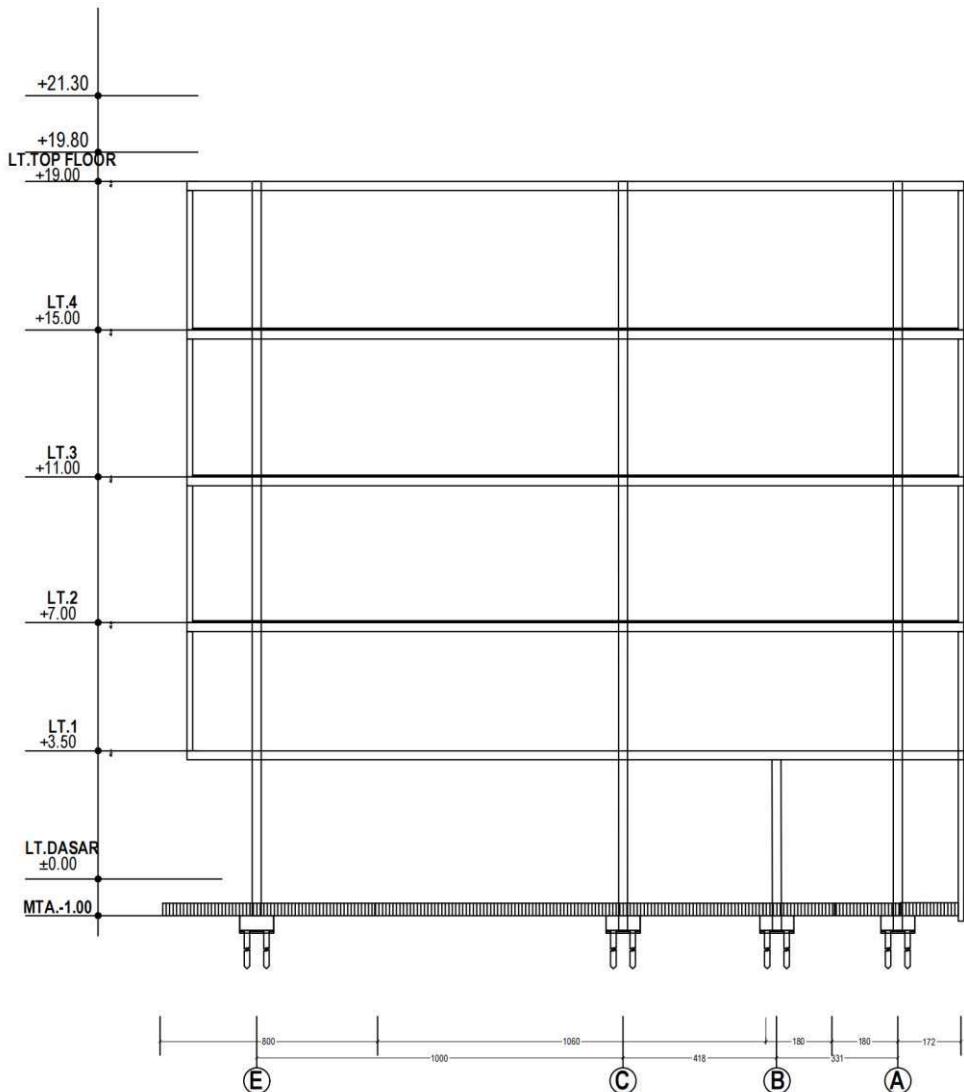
2 Rencana Kolom dan Balok Lantai 1
